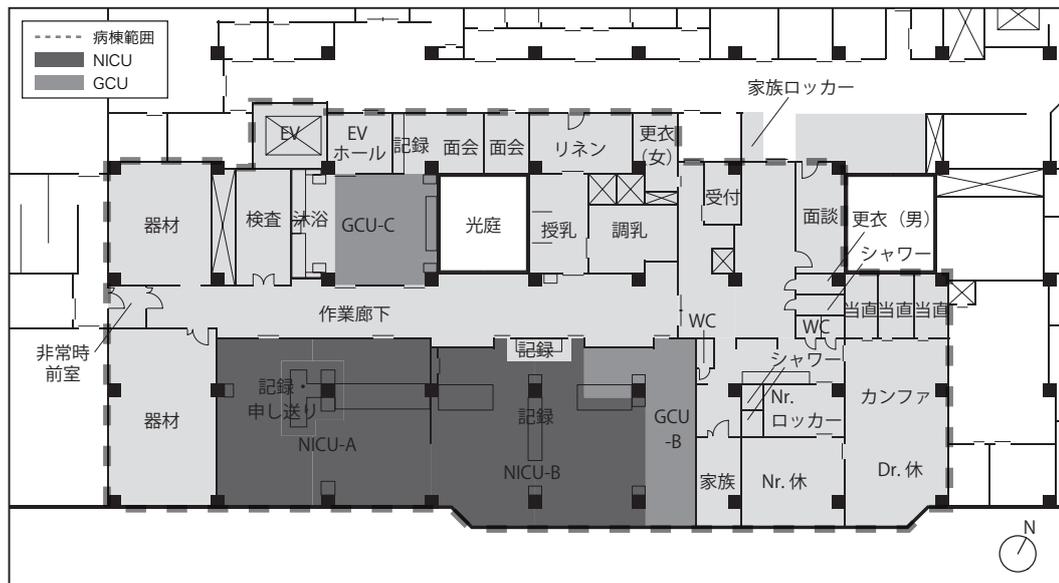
KC 病院の新生児病棟平面図 (S=1/400)
